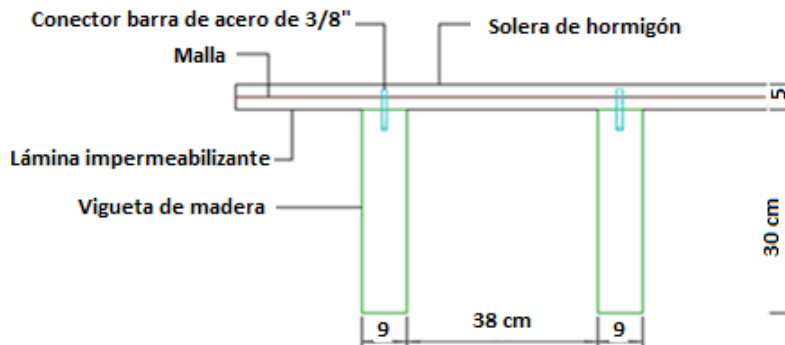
Sección transversal del forjado reforzado mediante sección compuesta madera-hormigón.
